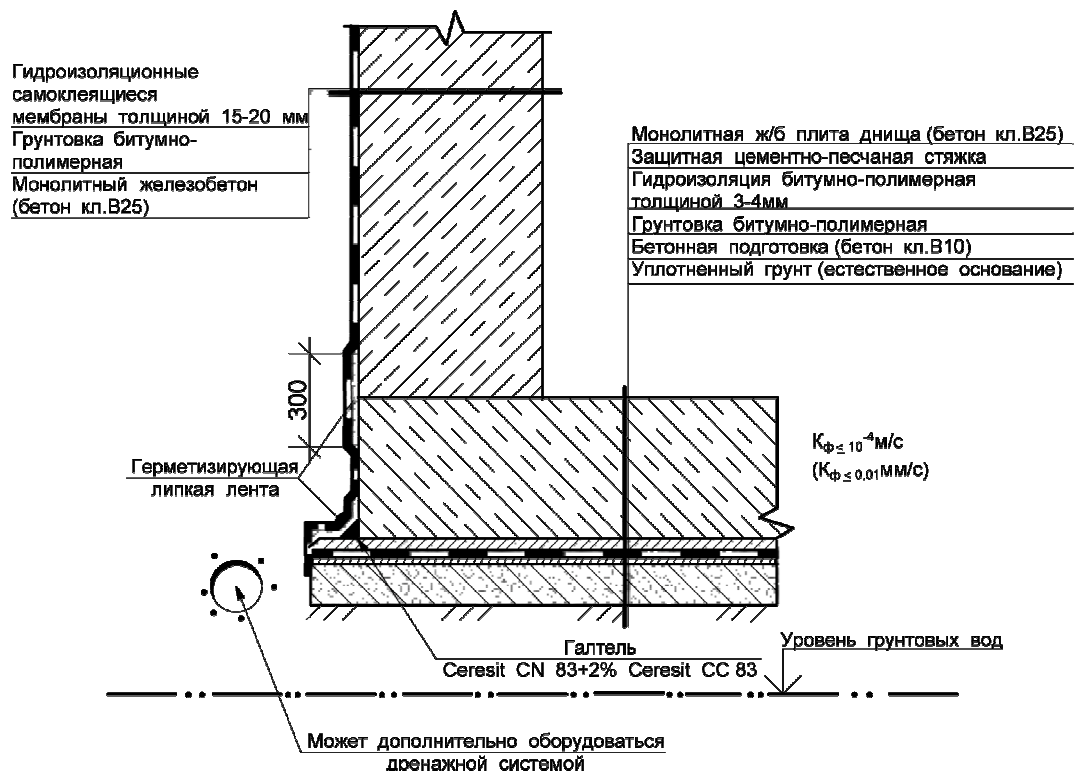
Наружная битумно-полимерная гидроизоляция бетонных плит оснований и стен подземных сооружений в условиях воздействия нескapливающейся филтpационной воды
